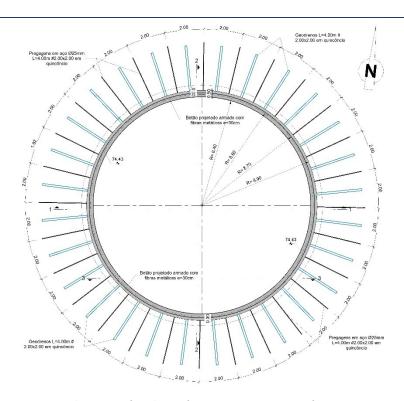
Planta tipo da solução de contenção provisória do poço PV215
